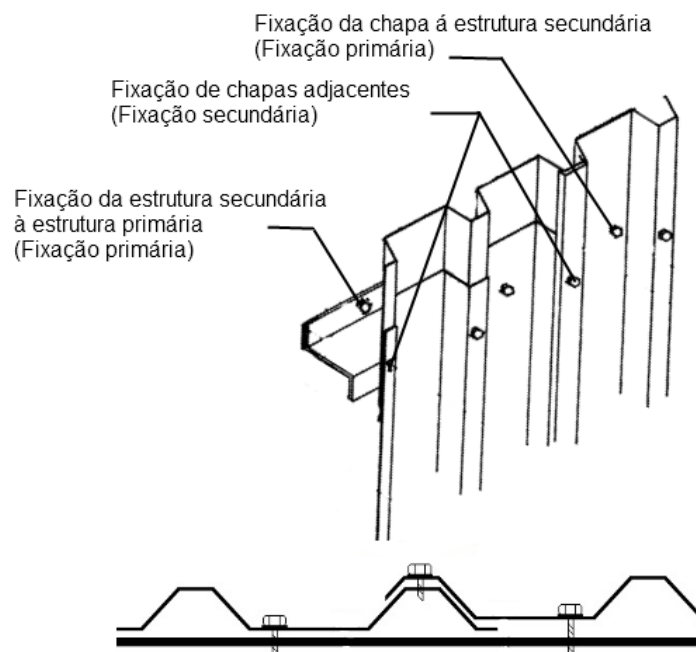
Fixação e sobreposição de chapas perfiladas trapezoidais. Adaptado de [18].
